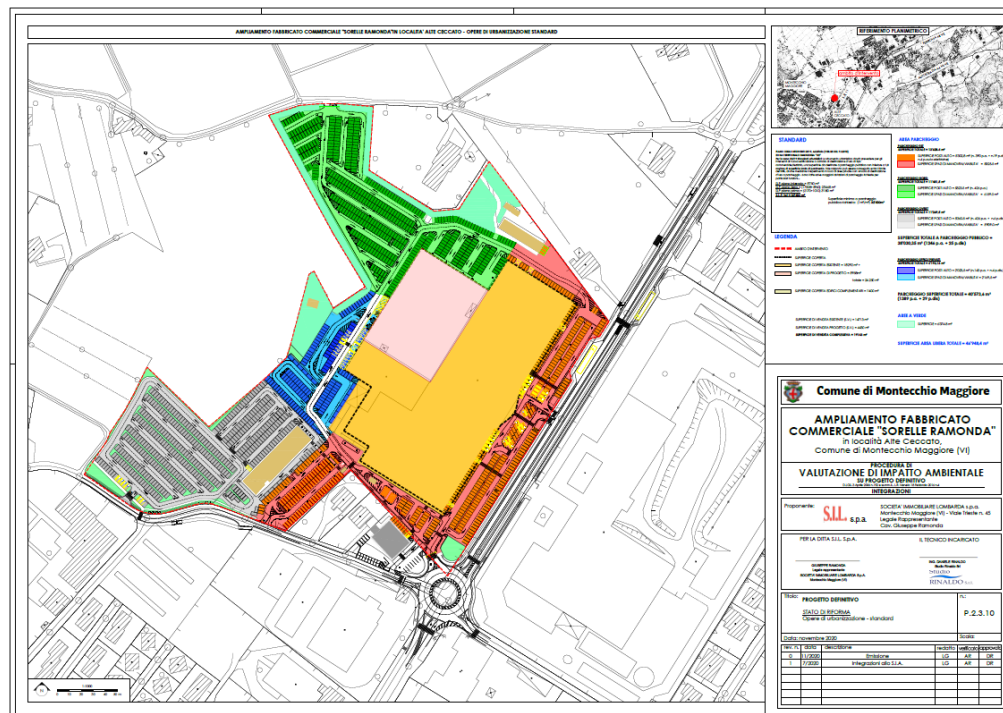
Stato di riforma: Tavola 2.3.10 Planimetria standard urbanistici
